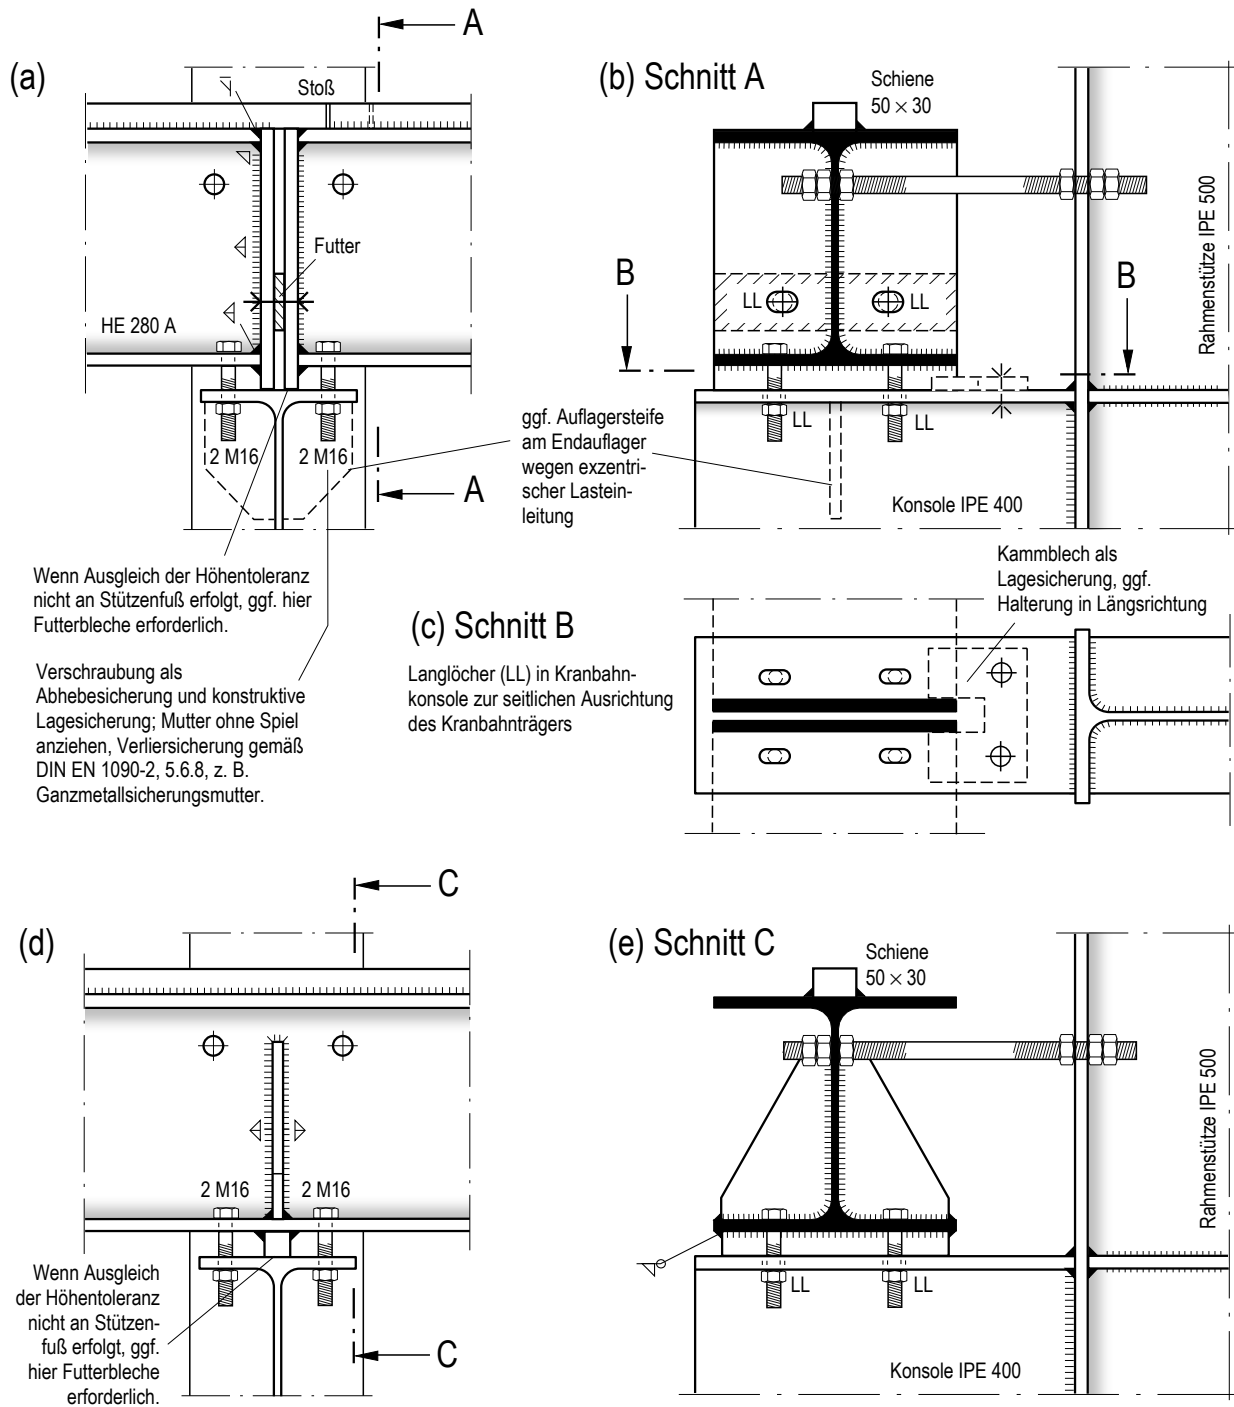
Ausführungsbeispiel eines Kranbahnträgers für leichten Kranbetrieb: Endauflager in (a) Längsansicht, (b) Querschnitt (Schnitt A), (c) Konsolenoberseite (Schnitt B); Zwischenaufleger bei mehrfeldrig durchlaufender Kranbahn: (d) Längsansicht, (e) Querschnitt (Schnitt C)
